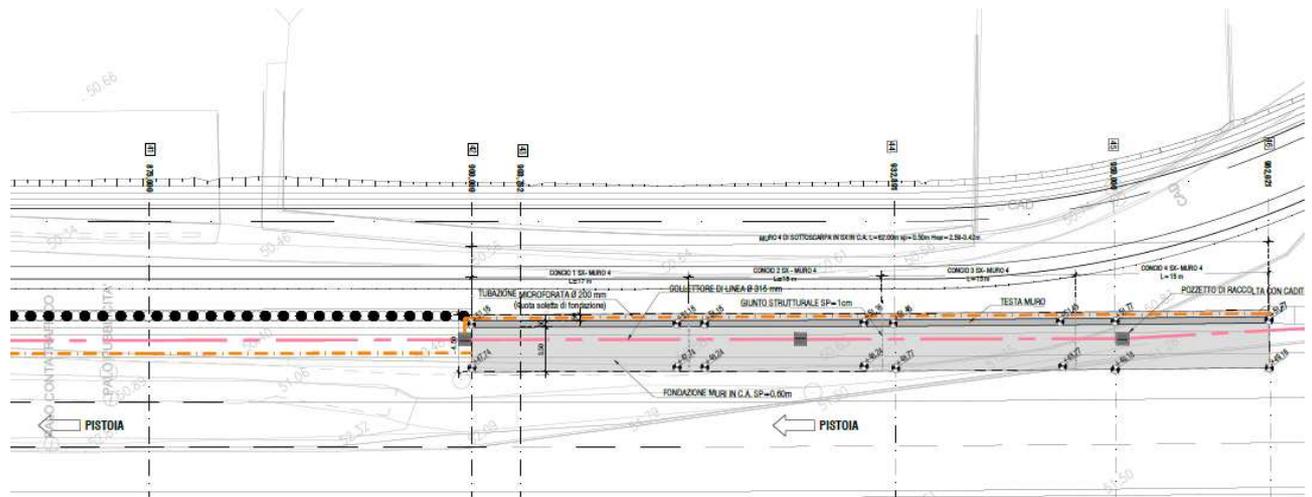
Stralcio planimetrico e prospetto muri di sottoscarpa 3 asse dx in direzione Firenze
